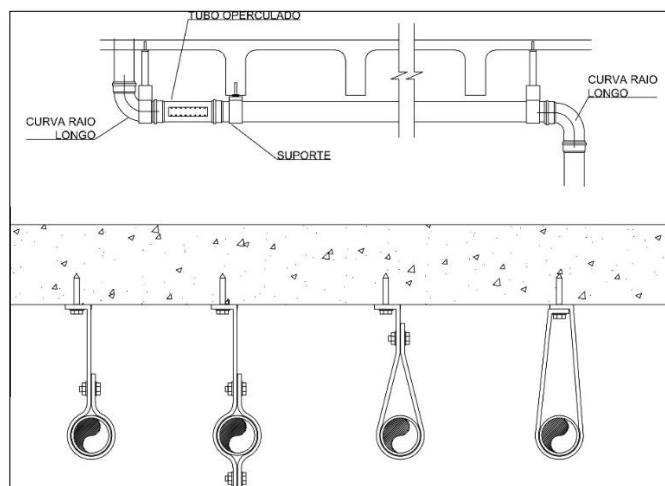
Detalhe Construtivo - Tipos de fixação de tubulação
